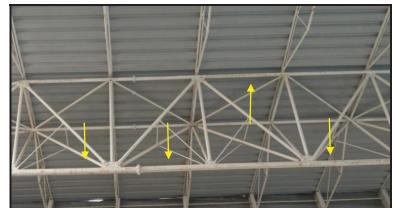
Estruturas metálicas da cobertura do Complexo Aquático da UNISUL com ferrugem.
